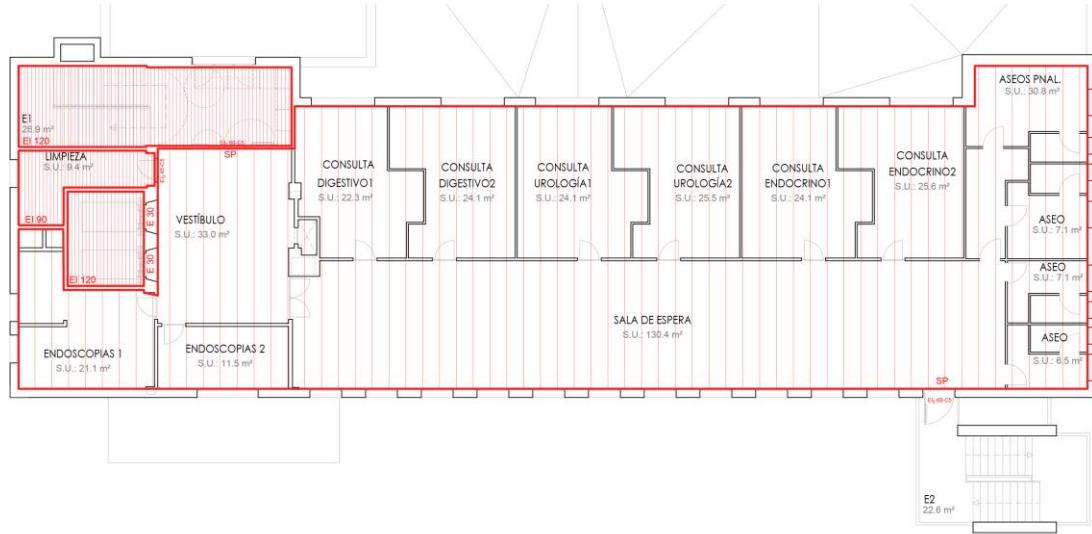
Planta de sectorización de la planta segunda. (Planta tipo)
